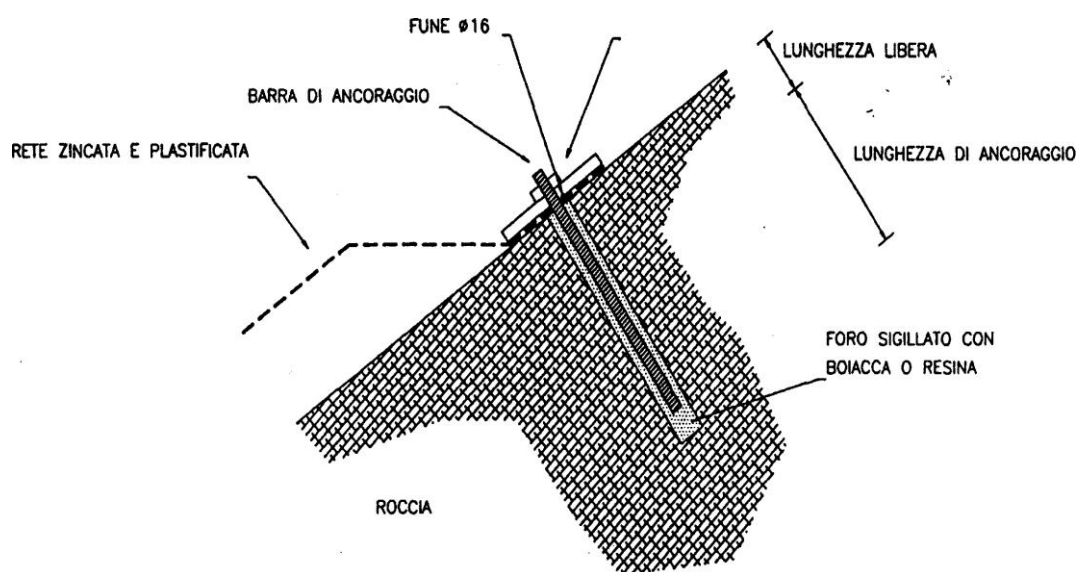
Rappresentazione grafica di ancoraggio in roccia.
